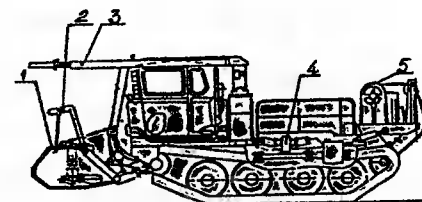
Кусторез роторный КР-2: 1 — рабочий орган; 2 — балка пригибающая; 3 — выдвижная стрела; 4 — насосная установка; 5 — лебедка
